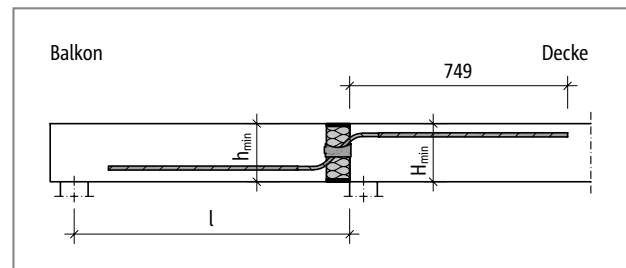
Schöck Isokorb® T Typ QP-V7 und QP-V9: Statisches System
